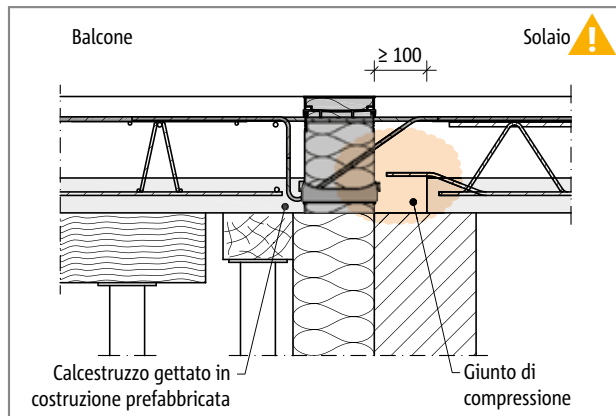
Schöck Isokorb® tipo KXT: appoggio diretto, montaggio con piastre prefabbricate (qui: $h \leq 200$ mm), giunto di compressione lato solaio
